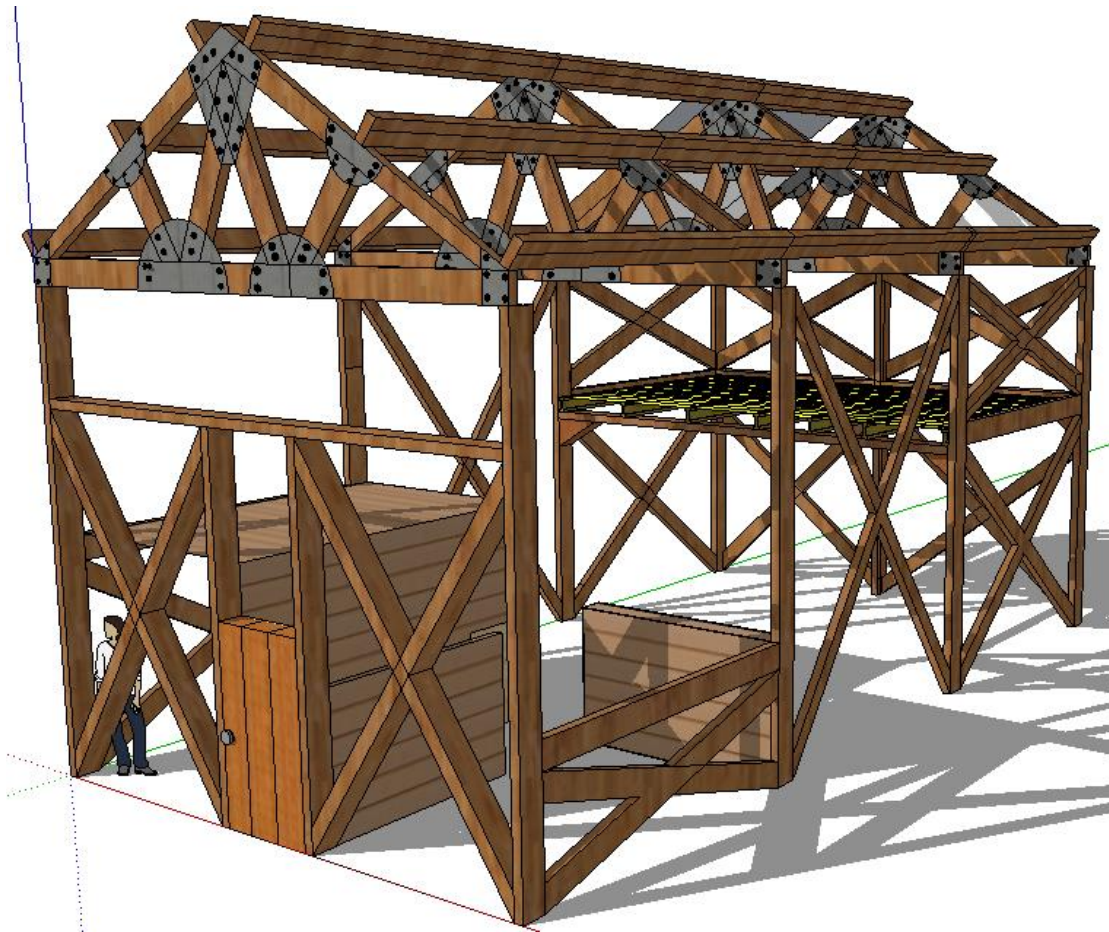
Viguetas, contra-venteos, vigas, y columnas de la casa.
